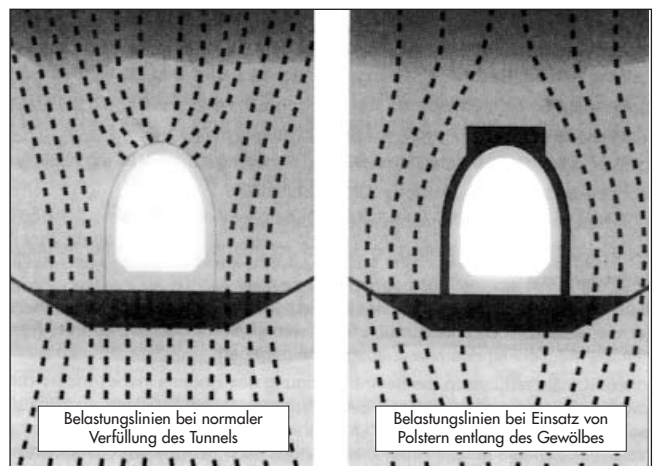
Lastenabweisende Lösungen im Tunnelbau
